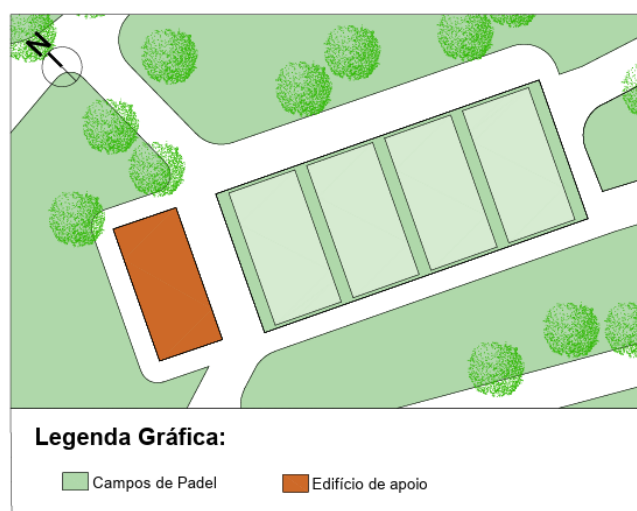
Planta de Pormenor dos Campos de Padel.
